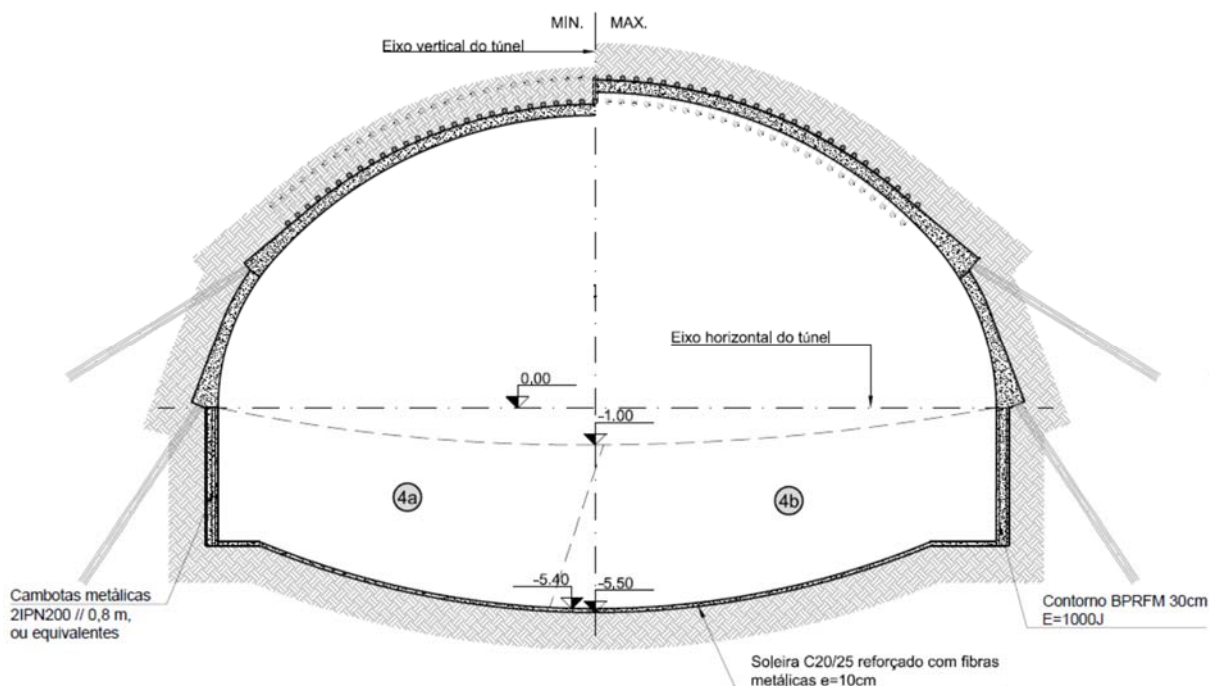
Seção tipo da fase 4 – rebaixo - escavação e suporte primário em ZG3
